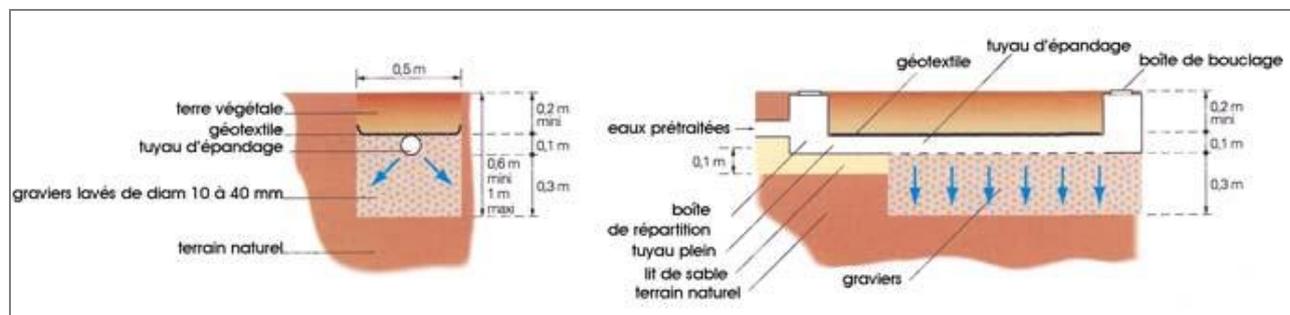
Schéma d'une tranchée d'infiltration (source : Landrur.fr)
